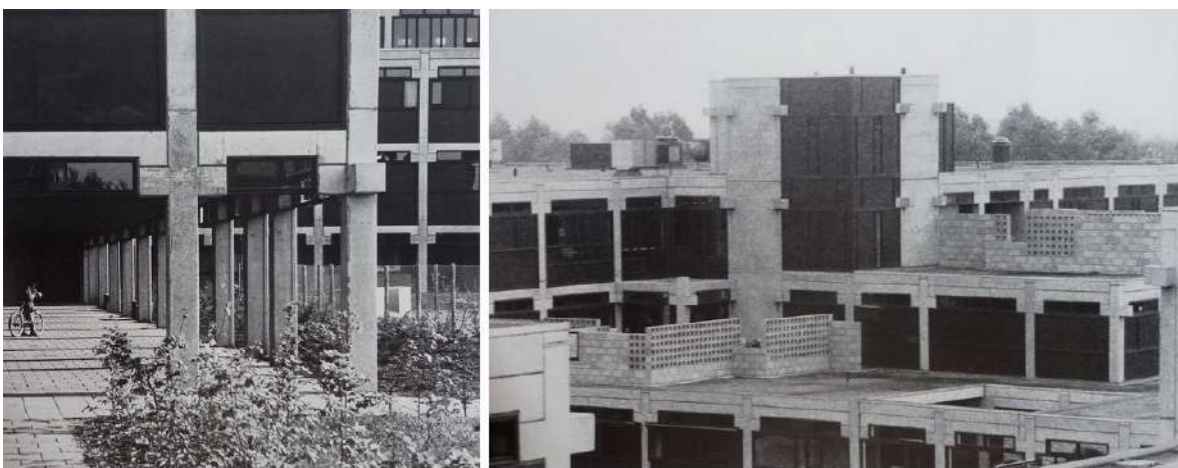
Estructura porticada en hormigón armado. Fuente: hiddenarchitecture.net
